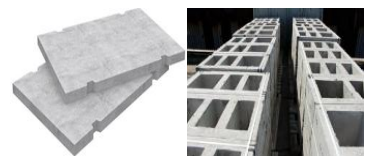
Плиты дорожные вентиляционные блоки
